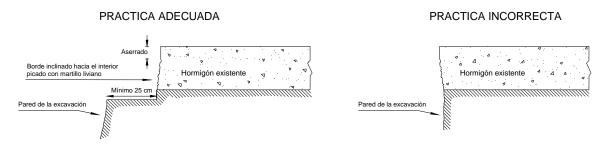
Sección transversal del corte de un pavimento y excavación. Prácticas adecuadas e incorrectas de bacheos en profundidad total o reparación (o nuevo tendido) de servicios públicos, en pavimentos para tránsito liviano.
